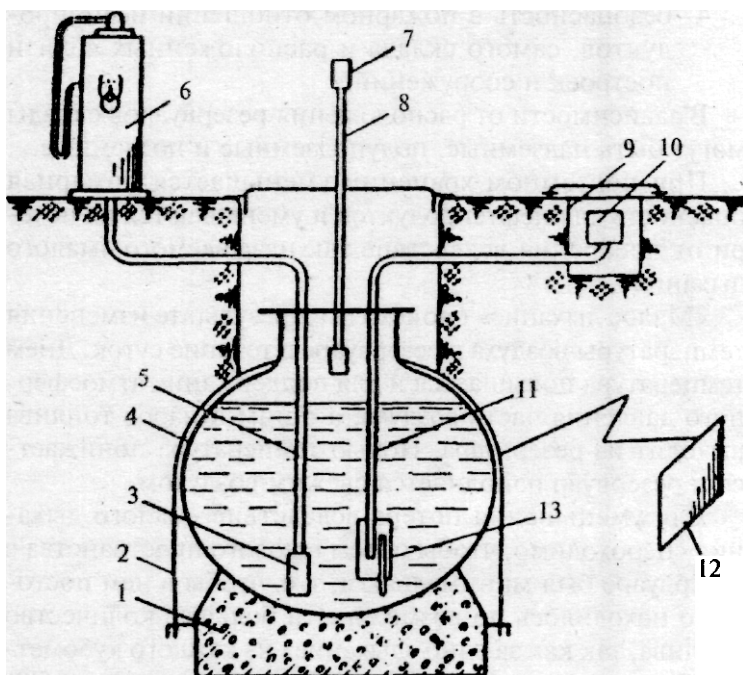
Схема подземного расположения резервуара и его оборудования:
